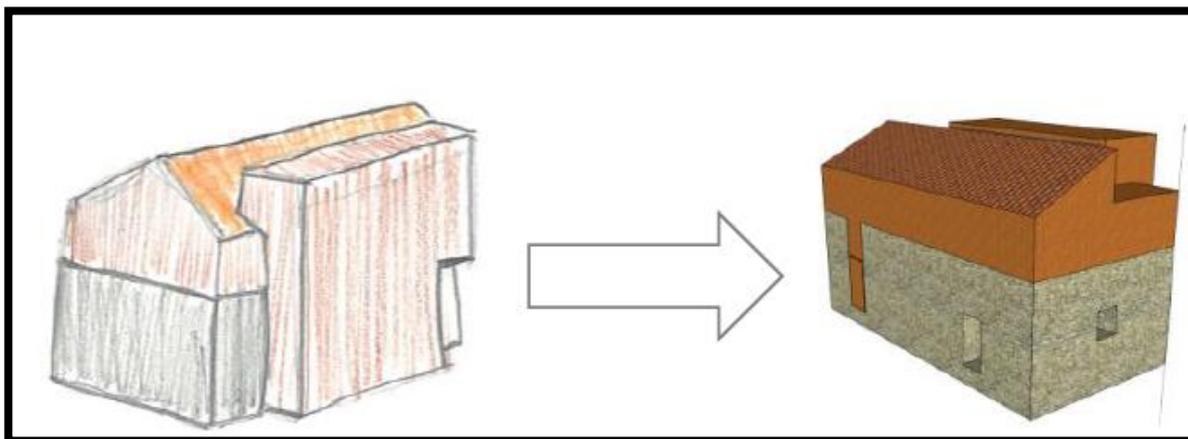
Vistas isométricas exteriores propuestas para las viviendas con tipología predominante de un nivel.
